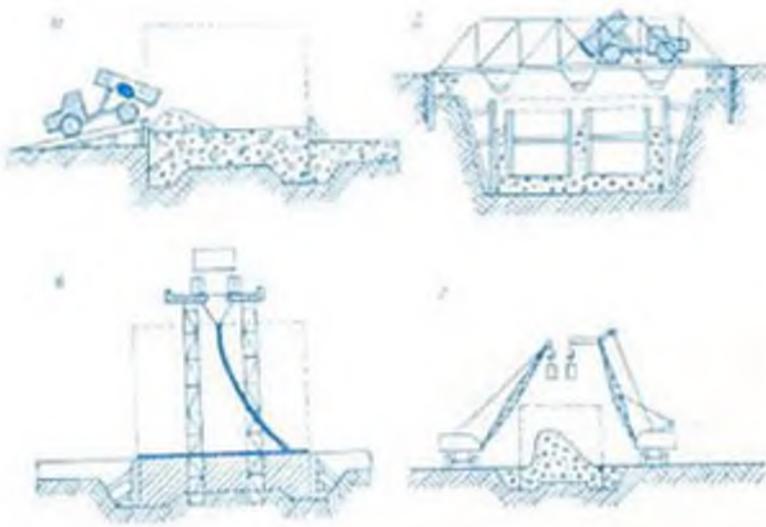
Бетонные работы. Укладка бетонной смеси: а — выгрузка смеси автомобилями-самосвалами непосредственно в блок; б — бетонирование с применением передвижных мостов; в — бетонирование с выгонами желобов с прохождением смеси по вибропроводам; г — укладка бетонной смеси передвижными подъемными кранами.
